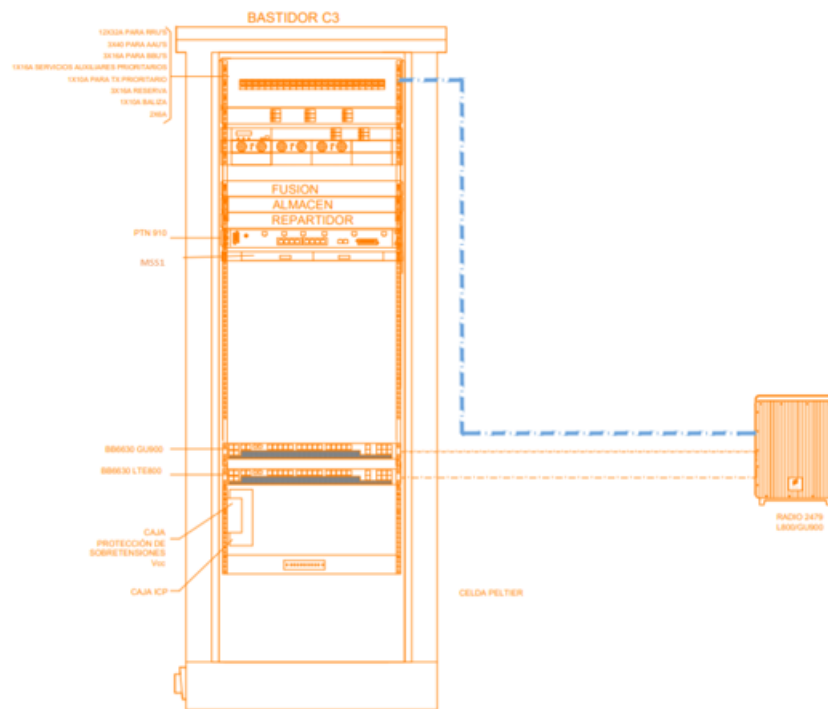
Esquema de equipamiento y conexión con RRu. Elaboración propia.
